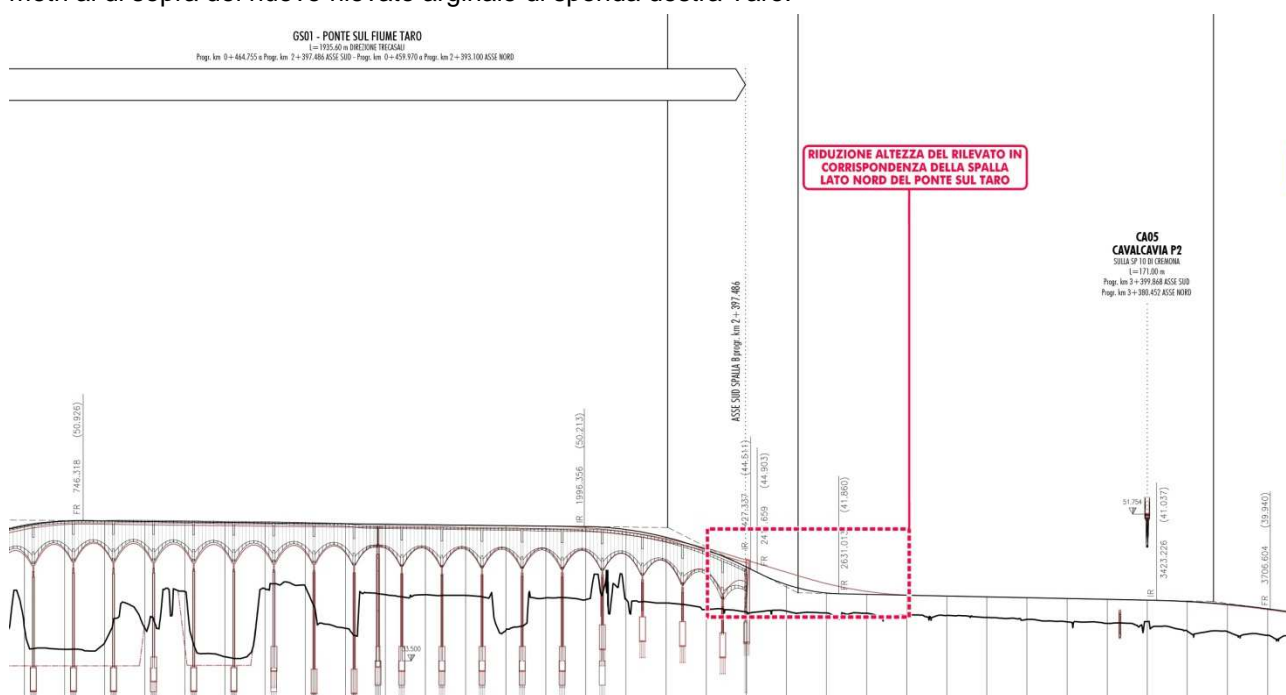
Tracciato autostradale – riduzione dell'altezza della spalla lato nord del Viadotto Taro
